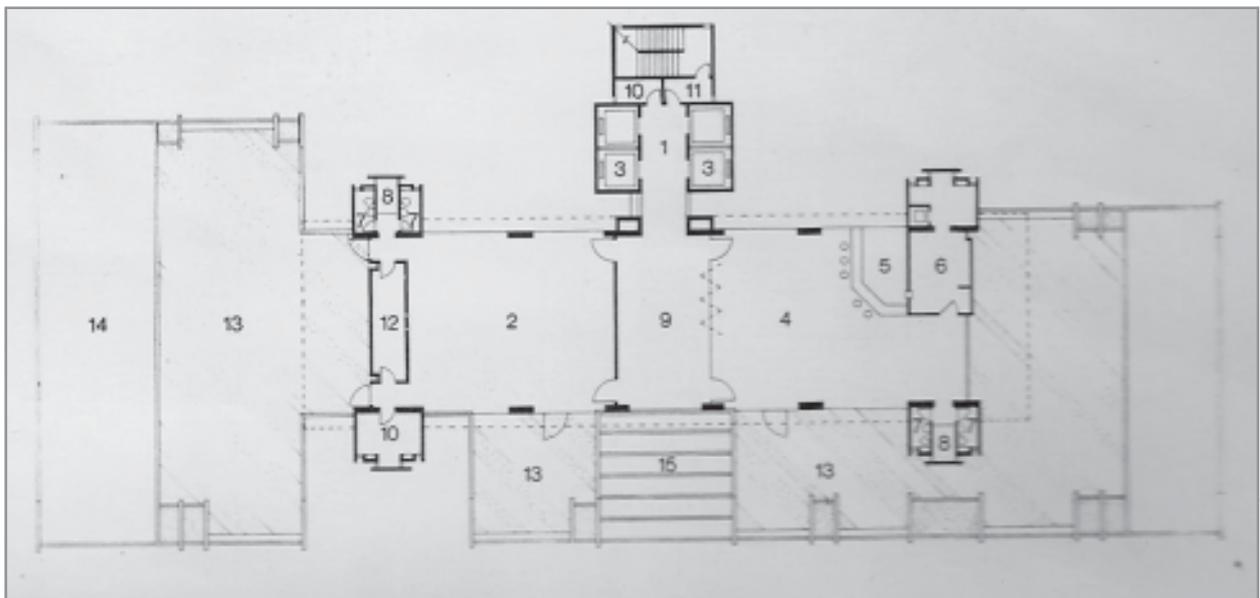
Planta do 1.º Pavimento - Fonte: Revista Projeto nº 110, Maio de 1988, página 90.
